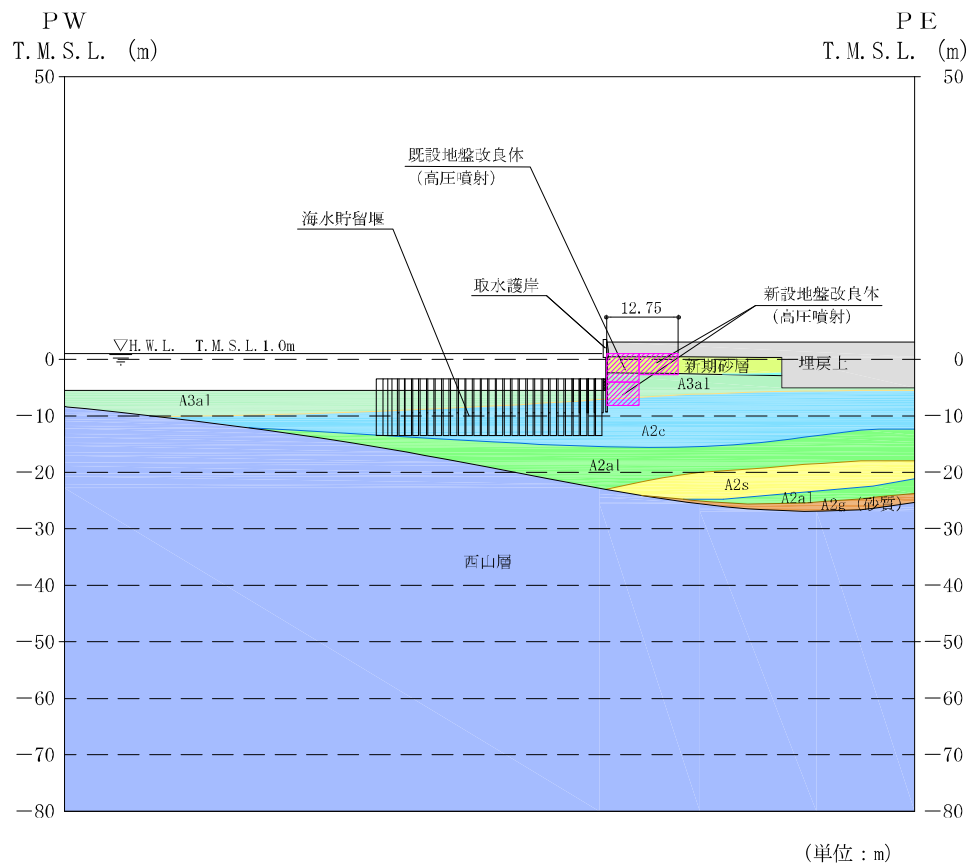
取水護岸の評価対象断面図 (A-A断面)
